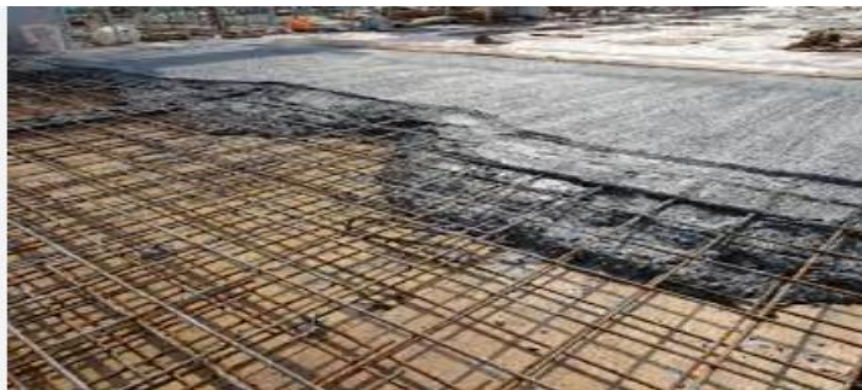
travaux de coulage de dalle en béton avec armature apparente.
